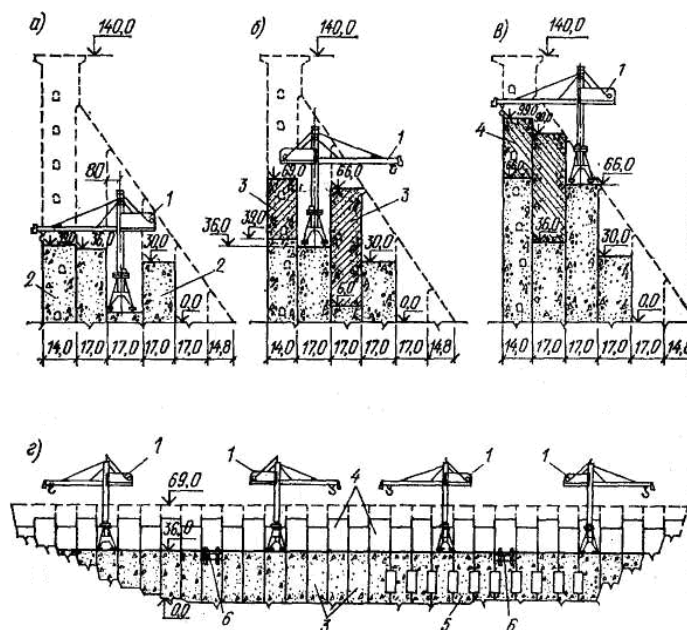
Схема возведения бетонных сооружений с размещением бетоноукладочных кранов на бетонных сооружениях
